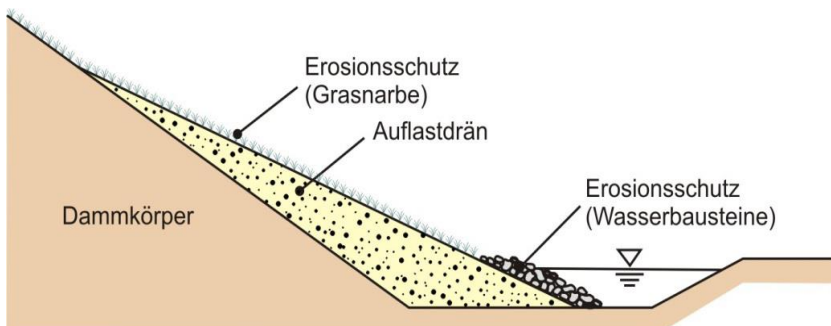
Auflastdrän mit Einstau durch ein Gewässer. [52]
